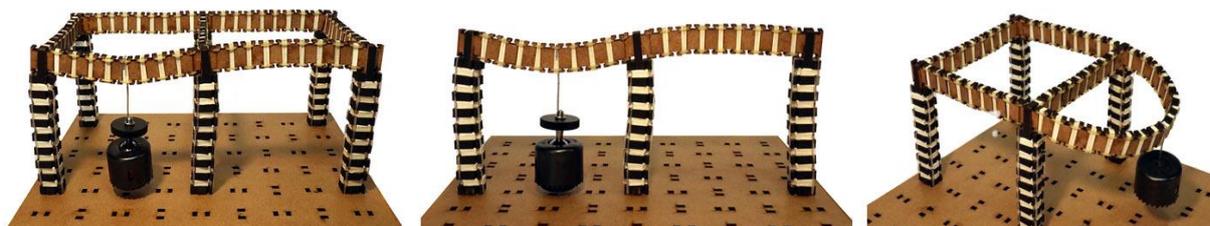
Possibilidades de montagens em pórticos planos, tridimensionais e com vigas em balanço. Fonte: LOBOSCO; CÂMARA, 2018.
